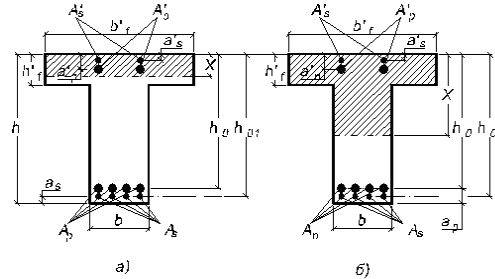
Розрахункова схема форми стиснутої зони в перерізах залізобетонних елементів із плитою в стиснутій зоні
